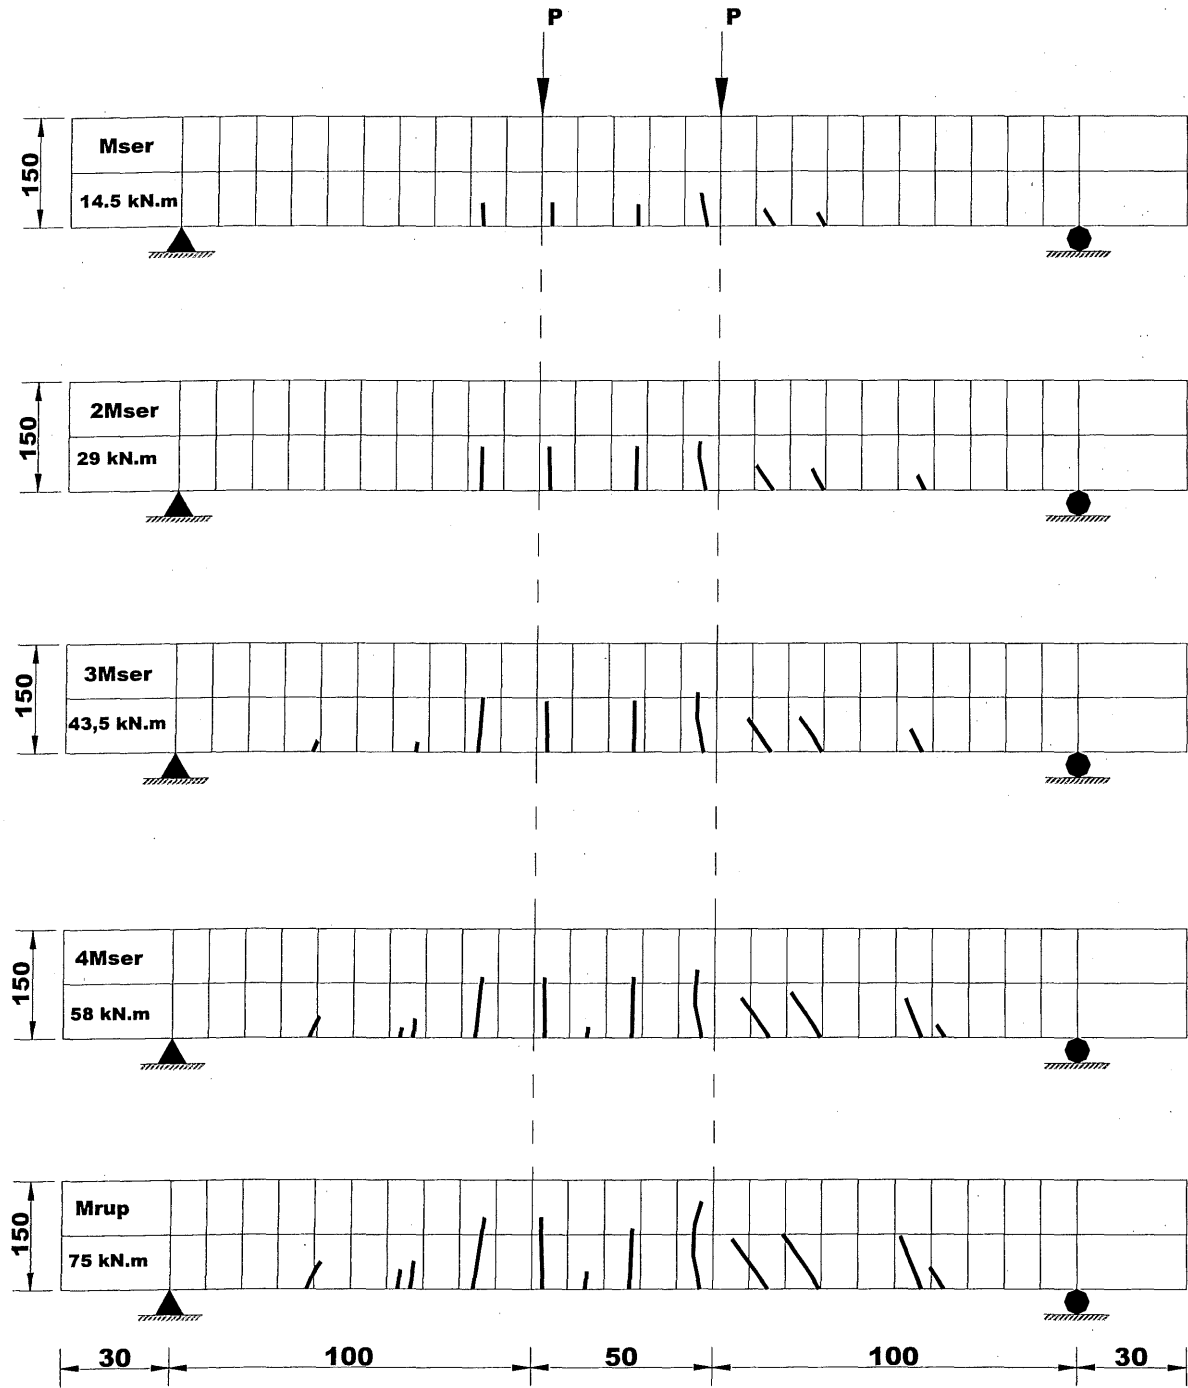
Propagation des fissures au niveau de la dalle S-CCI
